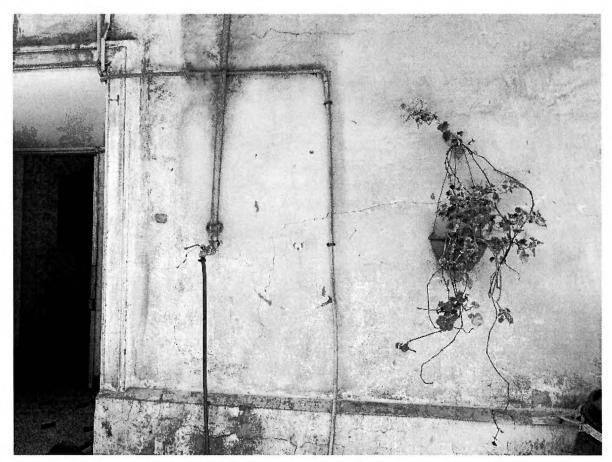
Fisuras en muros y aleros en fachada norte, patio interior.
